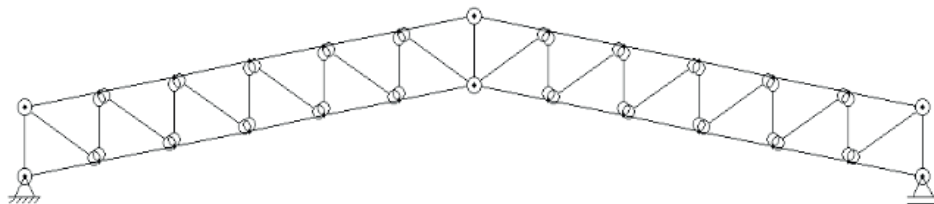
Esquema estrutural treliçado com banzos paralelos tipo Howe com inclinação de 10°
